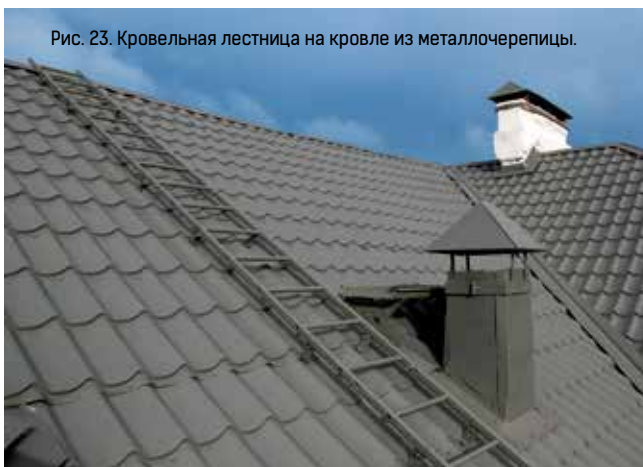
Кровельная лестница на кровле из металлочерепицы.
